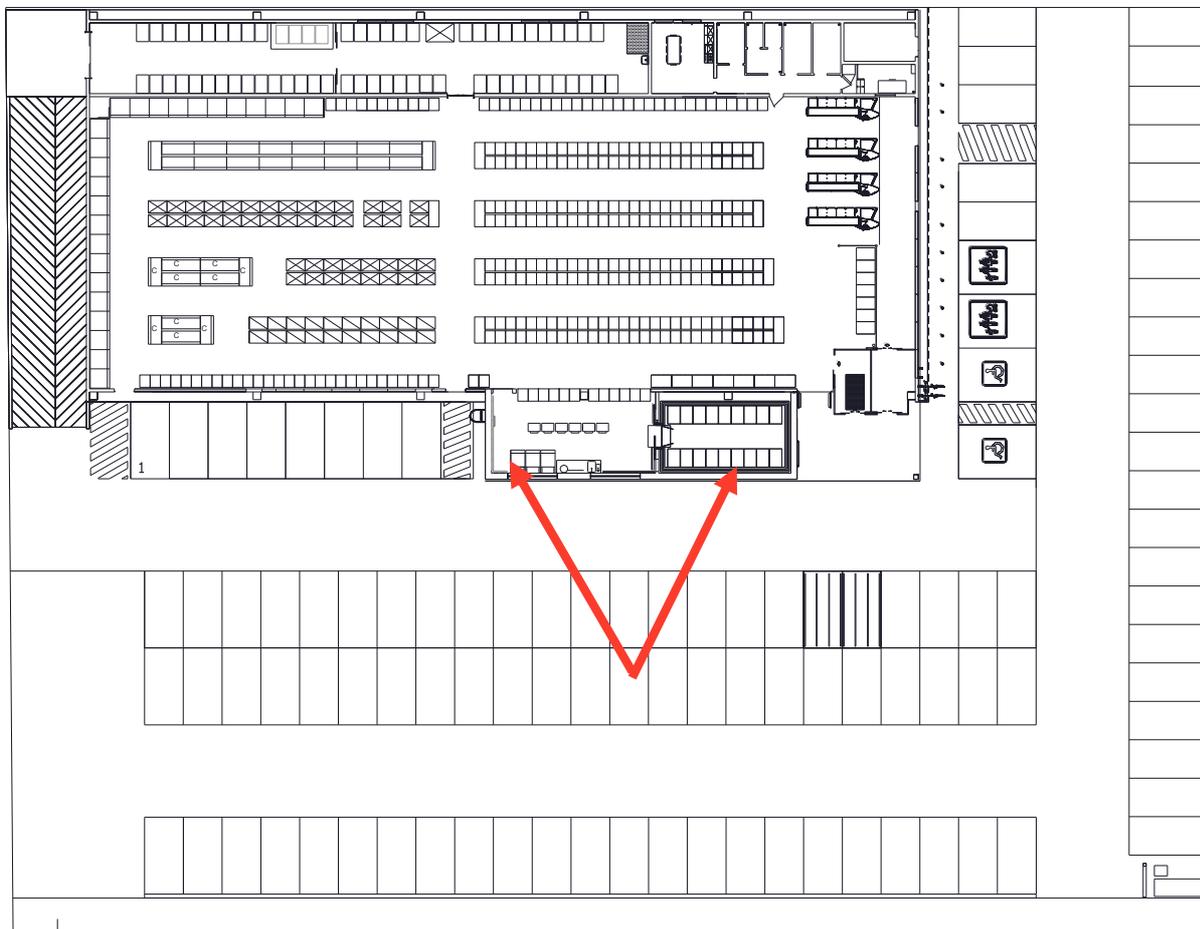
Stato di progetto, planimetria generale. Le frecce indicano l'ampliamento in progetto.
